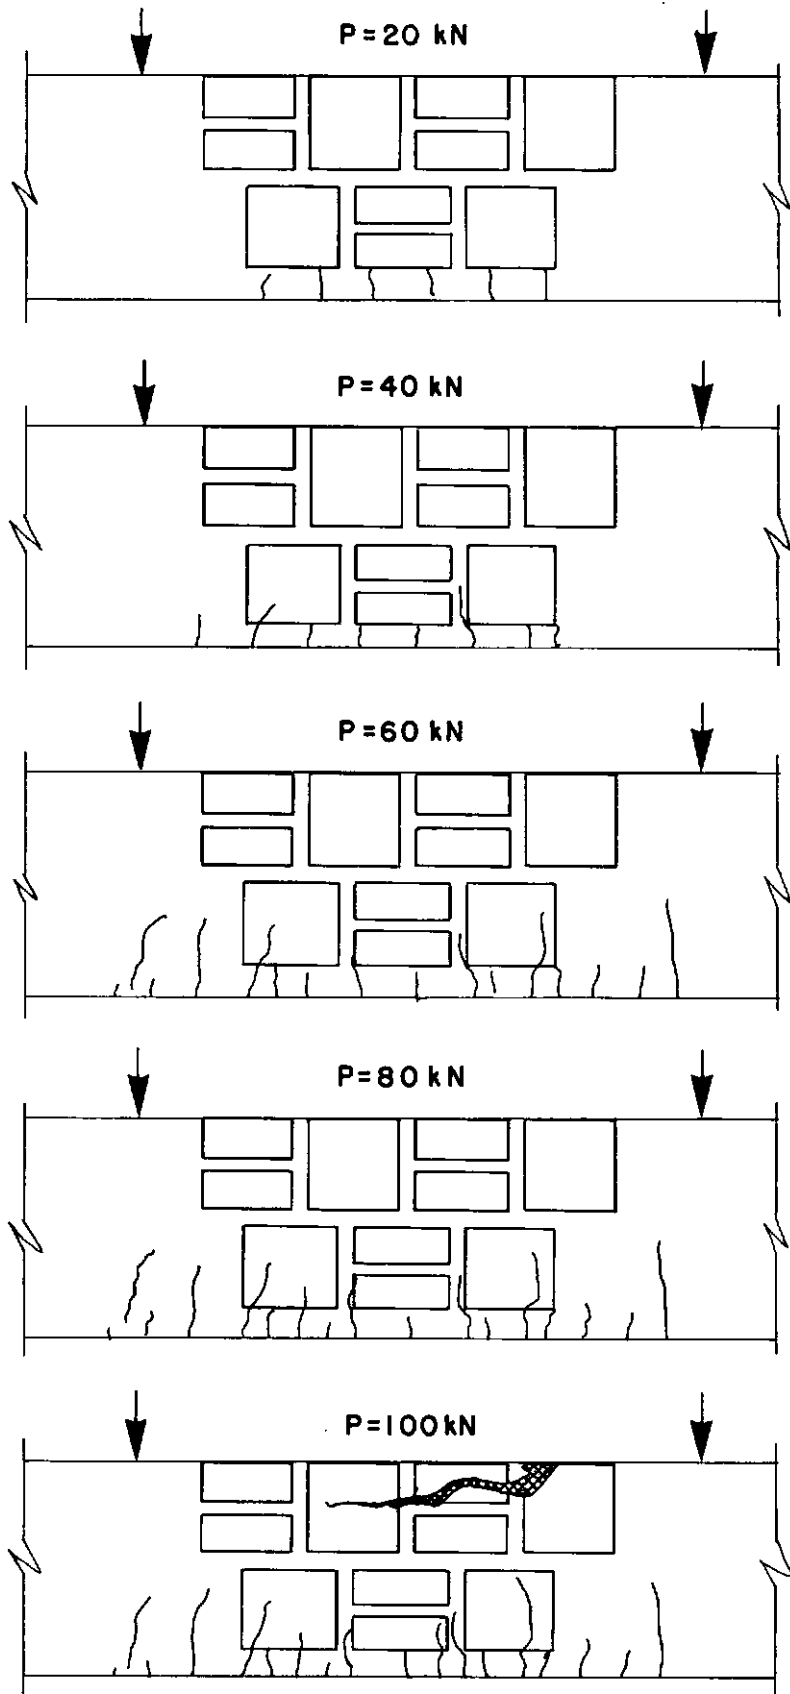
FISSURAÇÃO DA VIGA V4A
